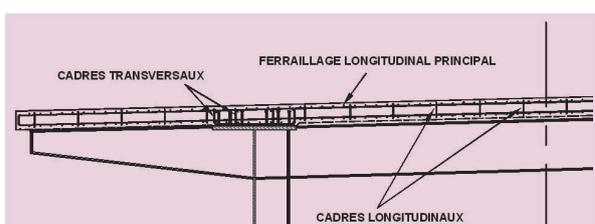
Principe de ferrailage courant de la dalle d'un tablier avec pièces de pont (hors ancrage des dispositifs de retenue)
